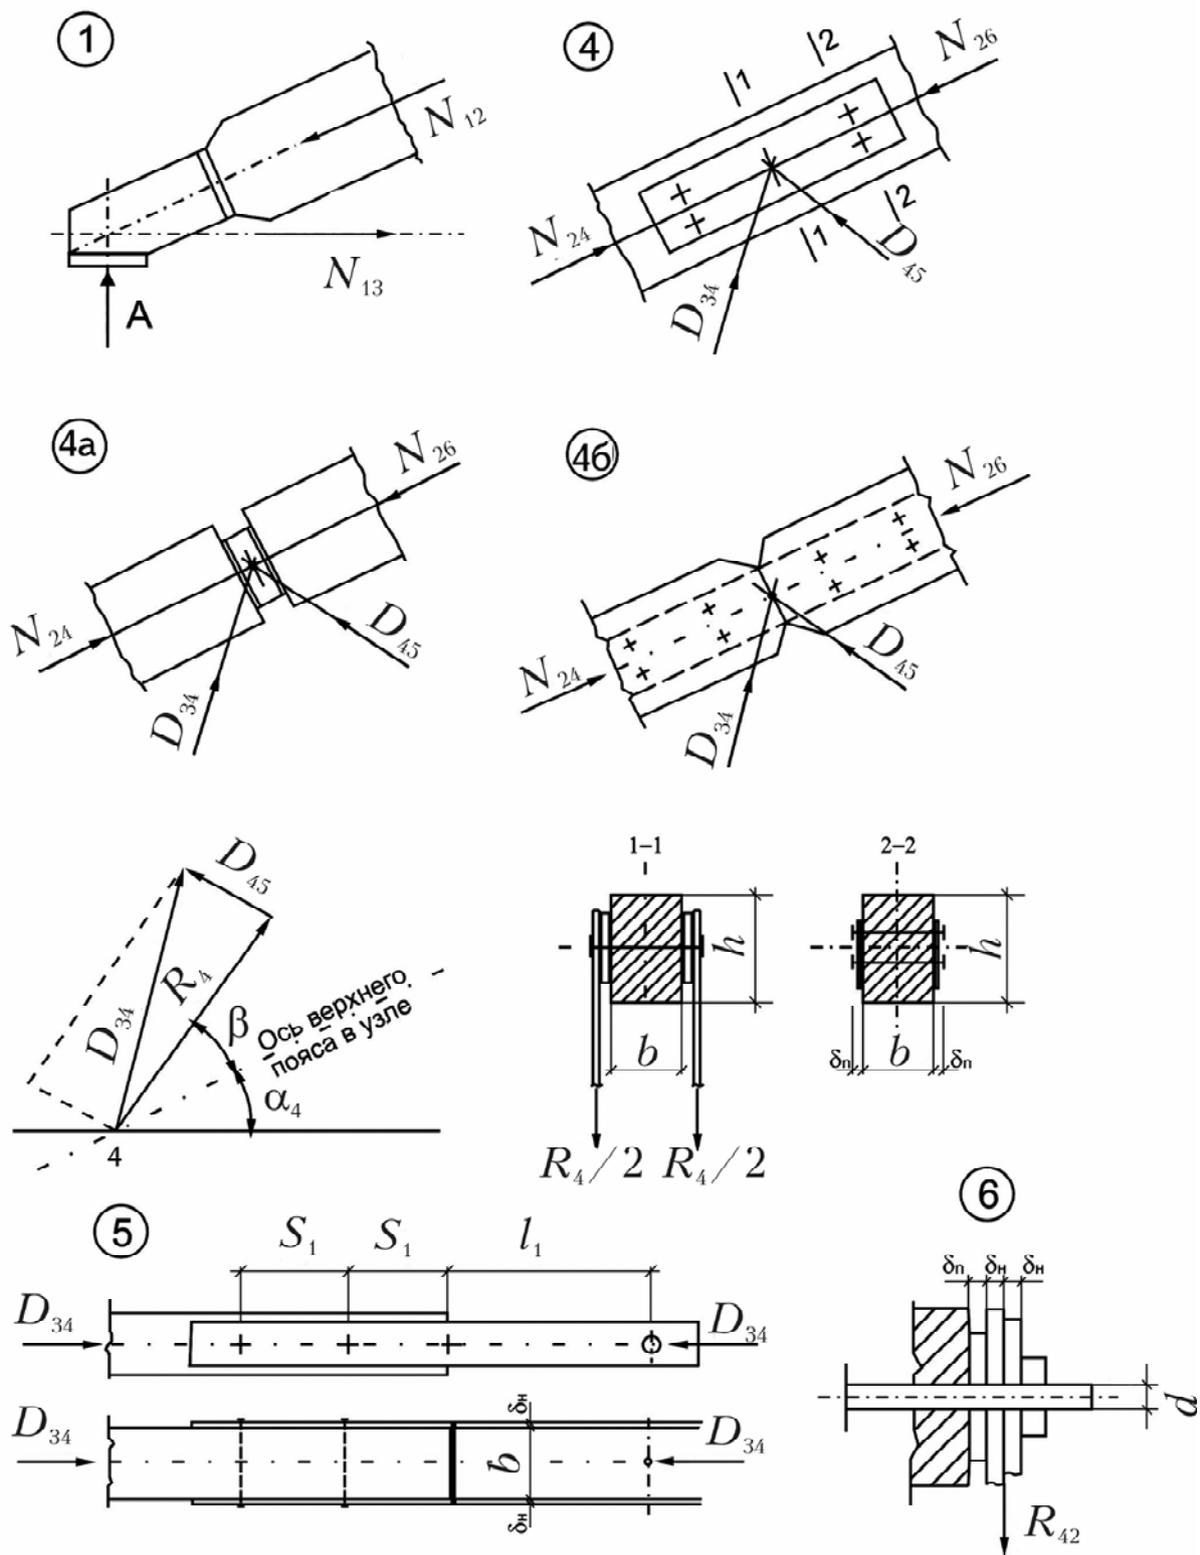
Конструктивные схемы узлов и деталей сегментных ферм
